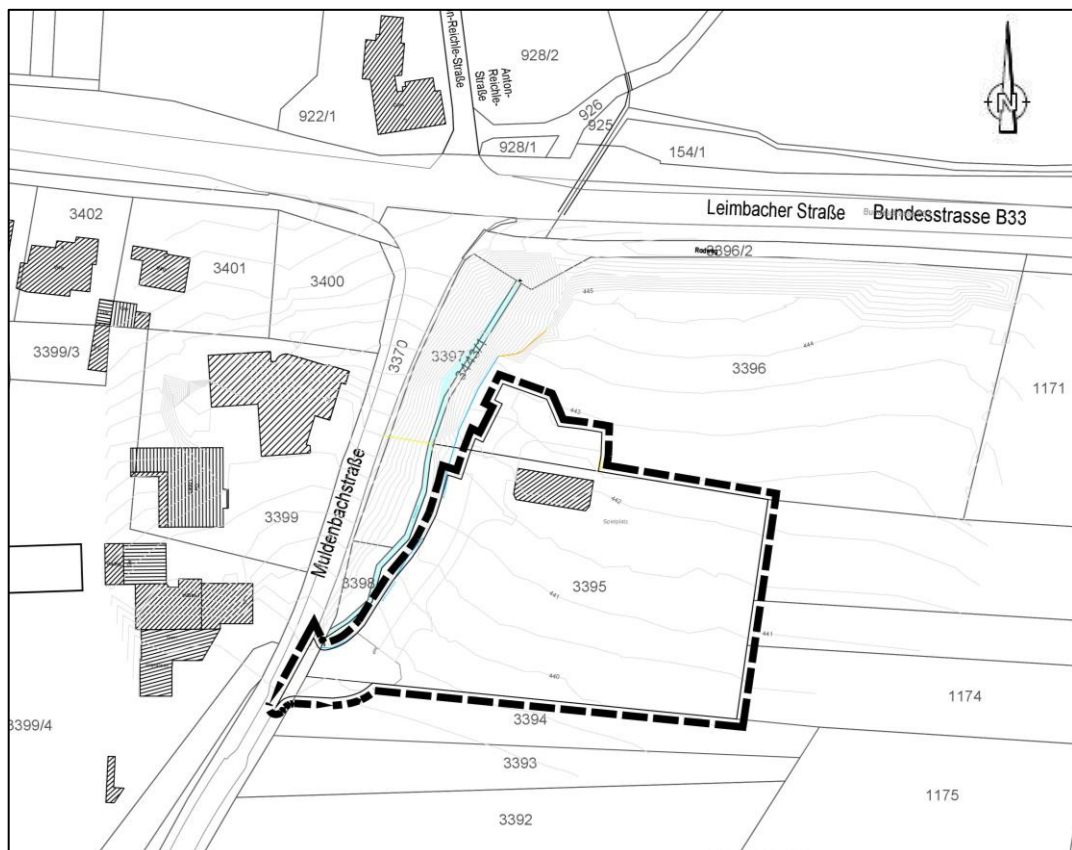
Lageplan mit Plangebiet, ohne Maßstab [1]
